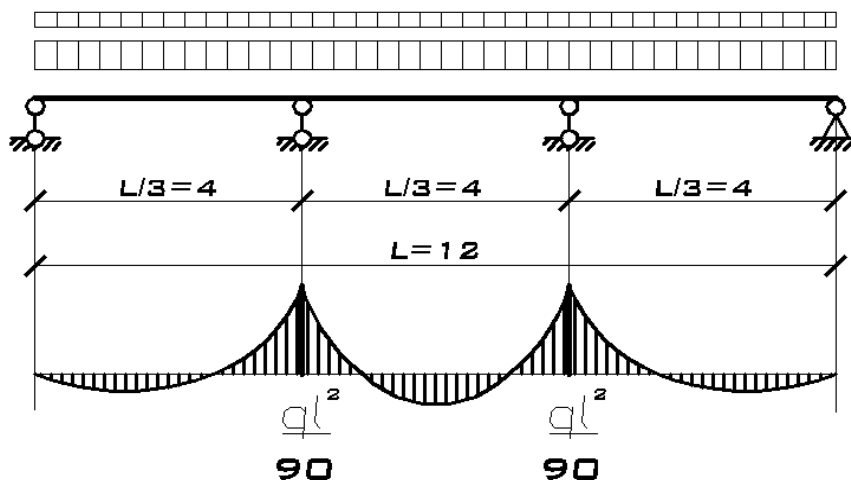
Расчетная схема шпренгельной балки с двумя стойками
